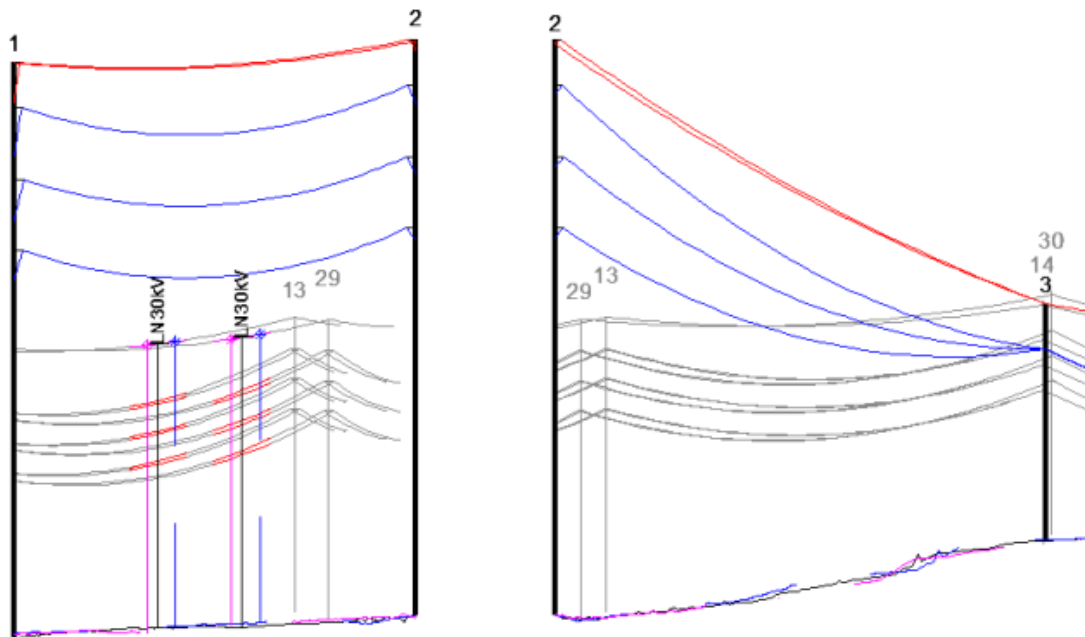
Planos de colisão entre apoios P1 e P3 da Alternativa 2
